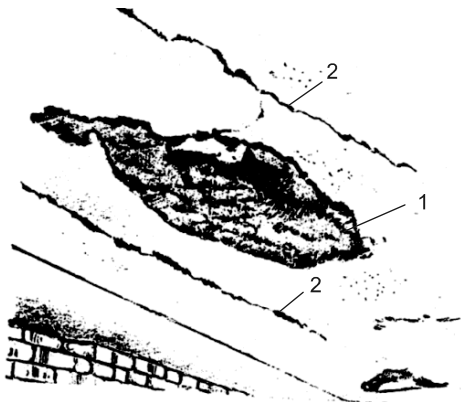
Разрушение плиты, произошедшее в результате замерзания талой воды в пустотах: 1 — выкол бетона; 2 — трещина вдоль пустоты
